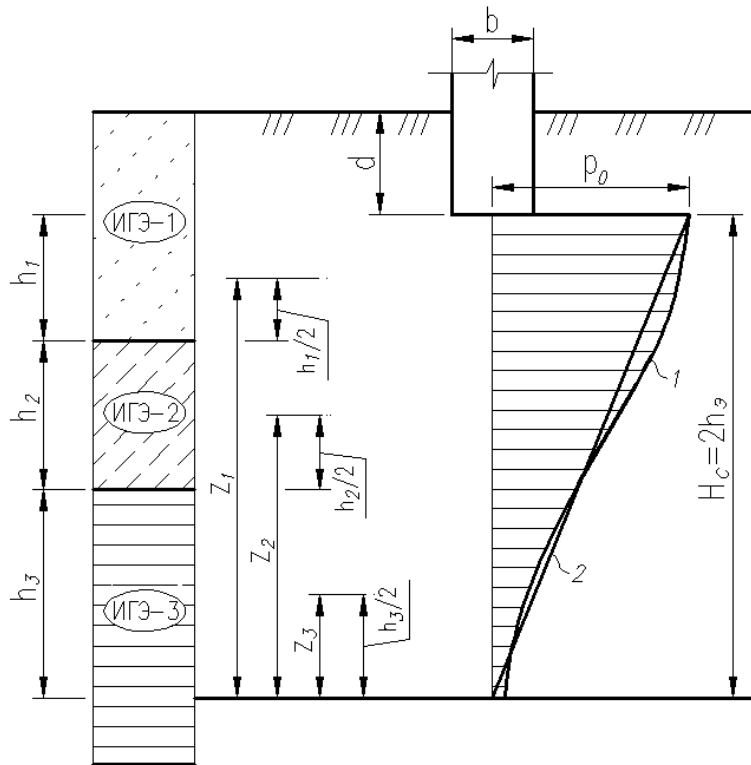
Схема к расчету осадки методом эквивалентного слоя для слоистого напластования грунтового основания:
